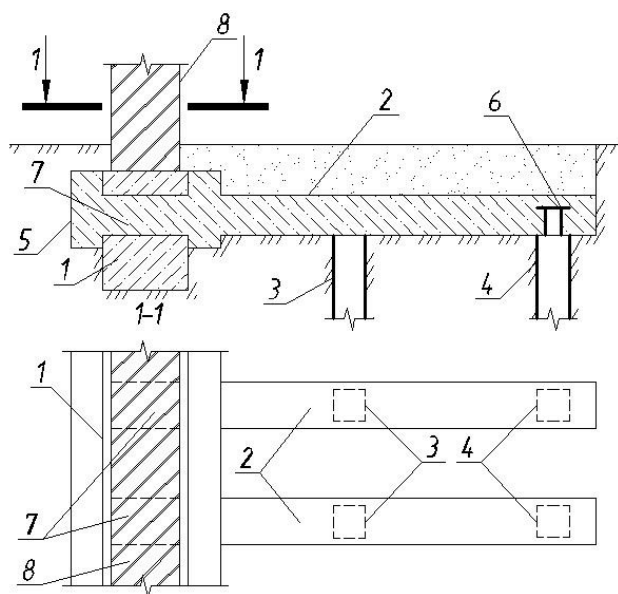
Улаштування виносних забивних паль із залізобетонними балками:
